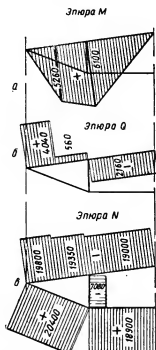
Эпюры расчетных усилий в элементах фермы: а — эпюра изгибающих моментов; б — эпюра поперечных сил; в — эпюра продольных сил.
